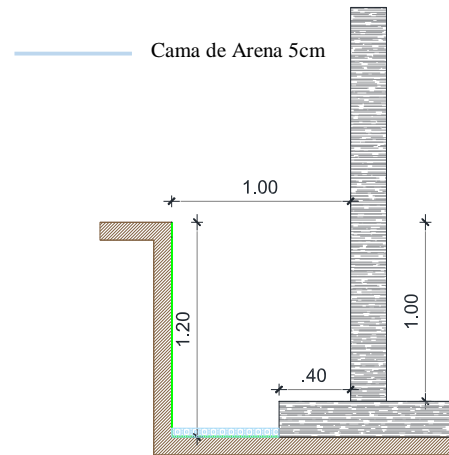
Detalle de Colocación Geo Textil Columna (S/E)
